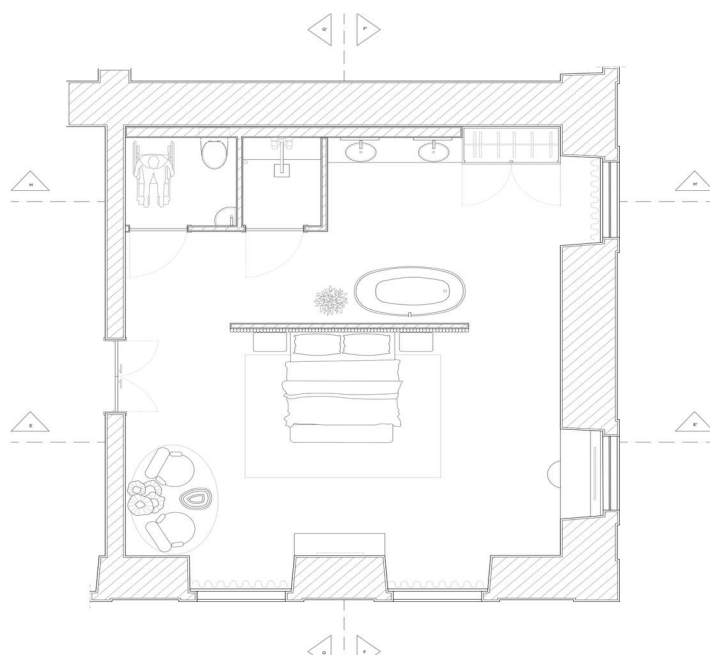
Planta de Pormenorização- Fonte: Bruna Monteiro
